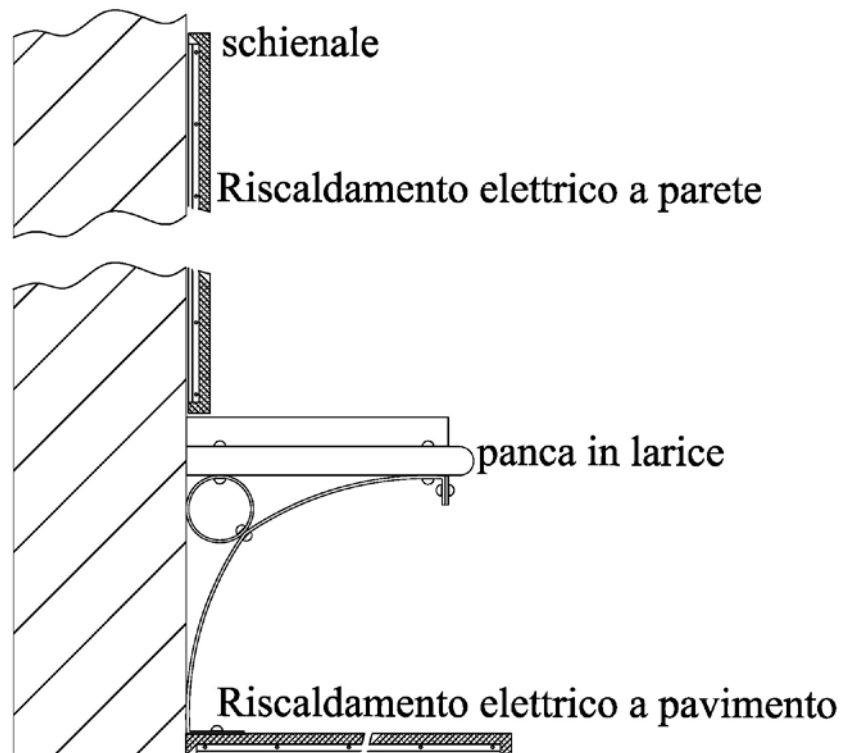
Sezione della panca realizzata con l'inserimento del riscaldamento elettrico a parete e pavimento
